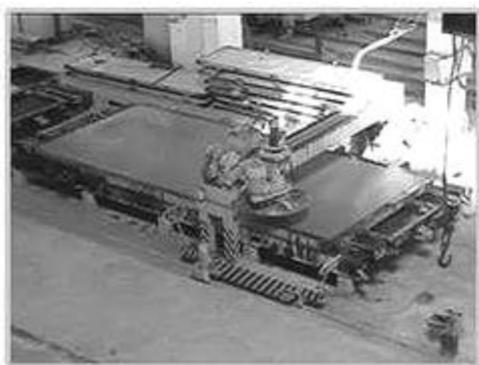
Производство стеновой панели в стационарном поддоне / A production of a wall panel is in a stationary pallet
